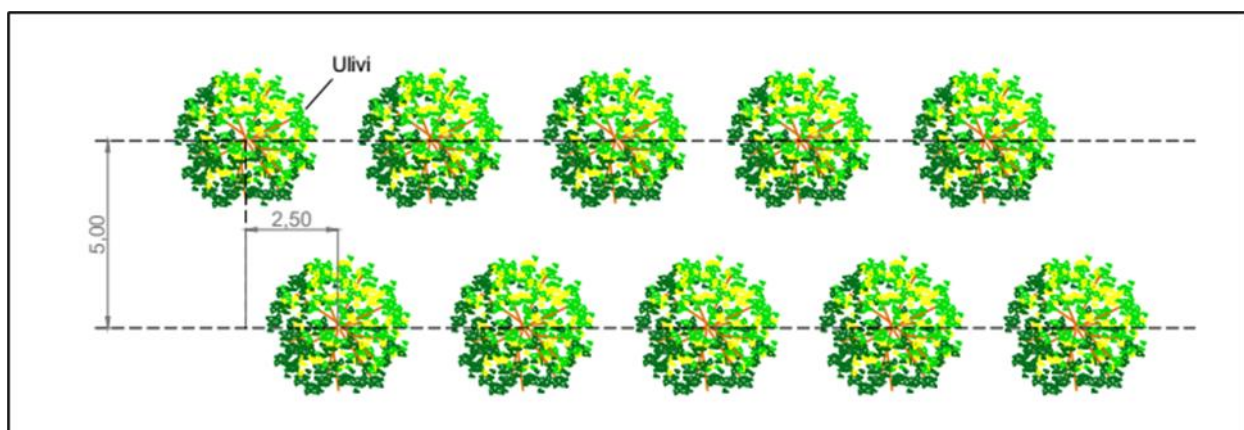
Disposizione sesto piante di ulivo sulle fasce perimetrali e sulle altre superfici di re-impianto
